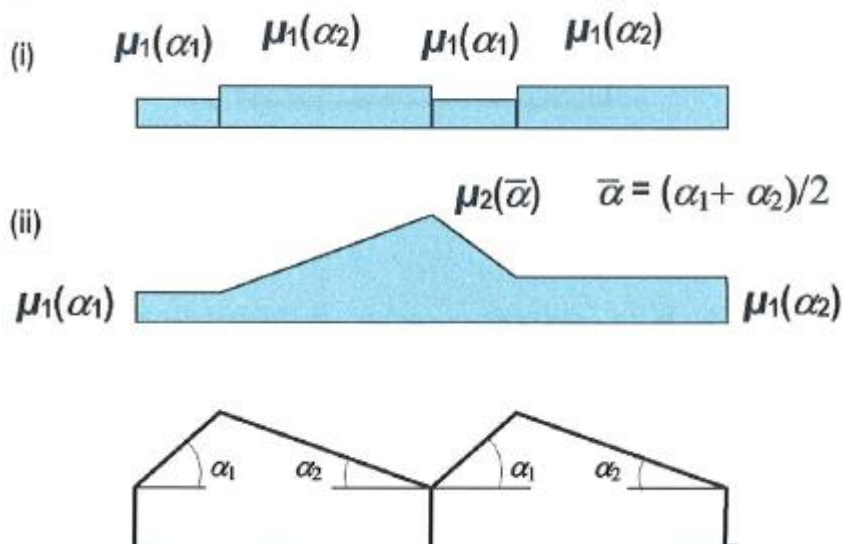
Współczynniki kształtu dachu – dachy dwuspadowe
